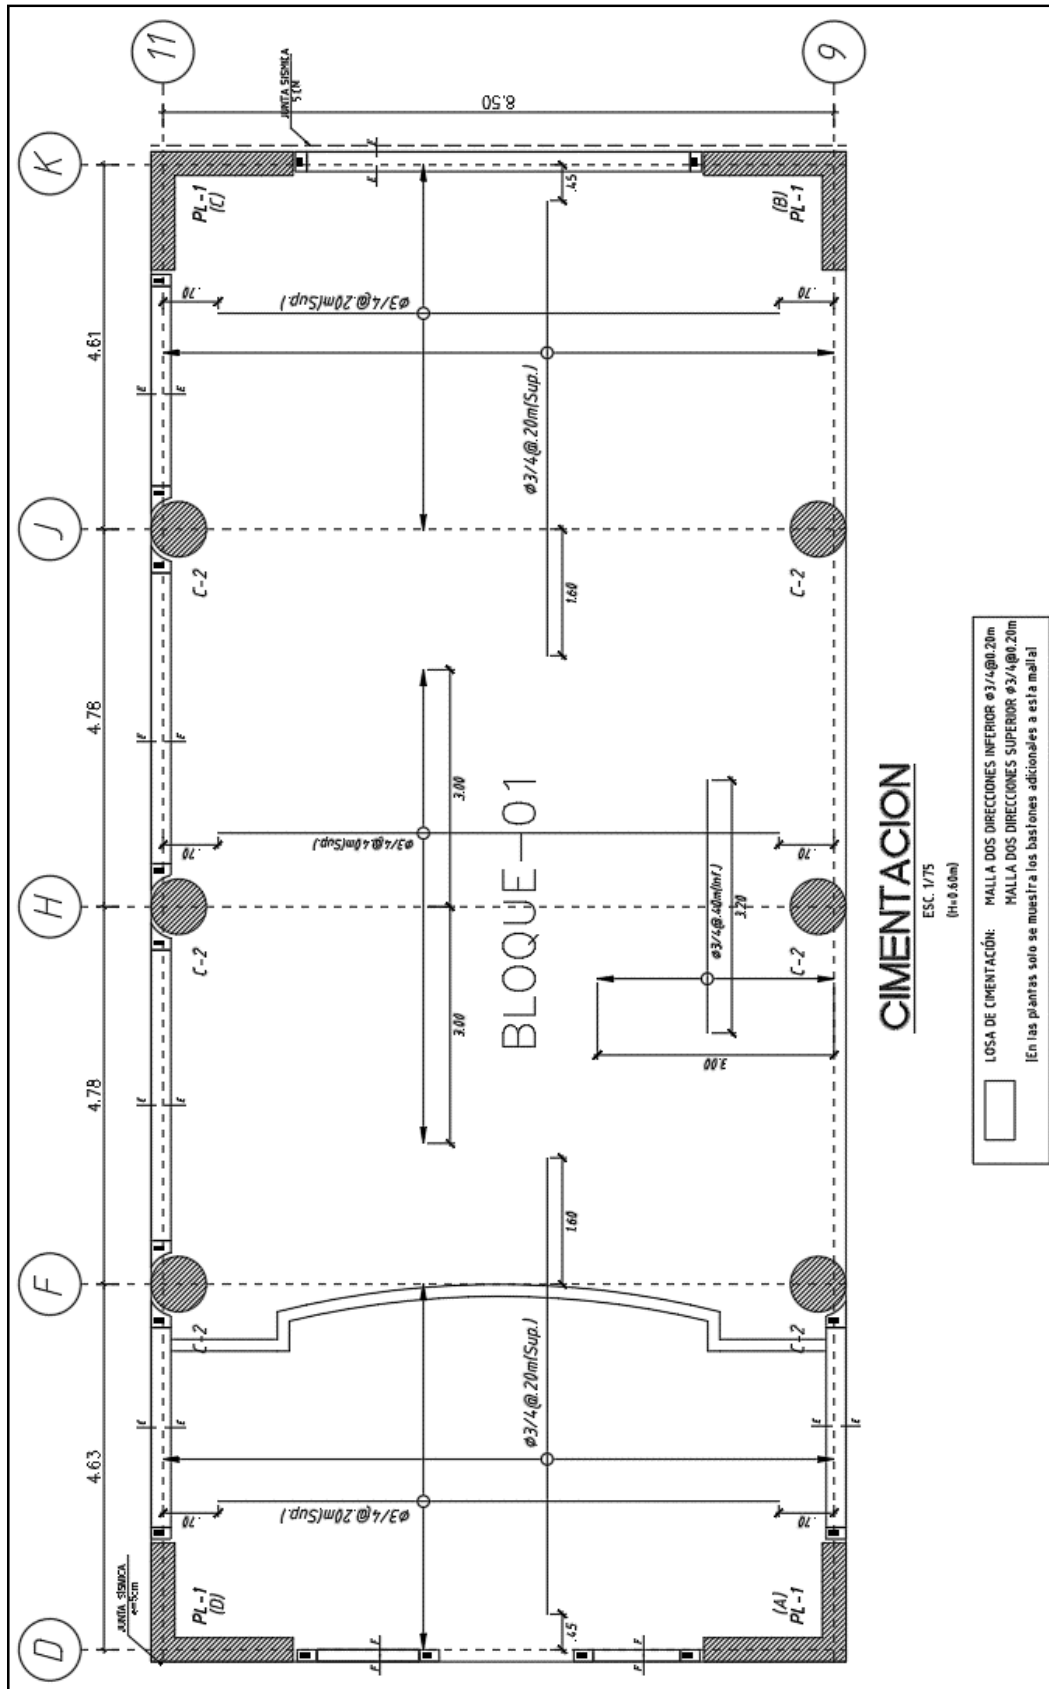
Diseño final de losa de cimentación del Bloque - I.
